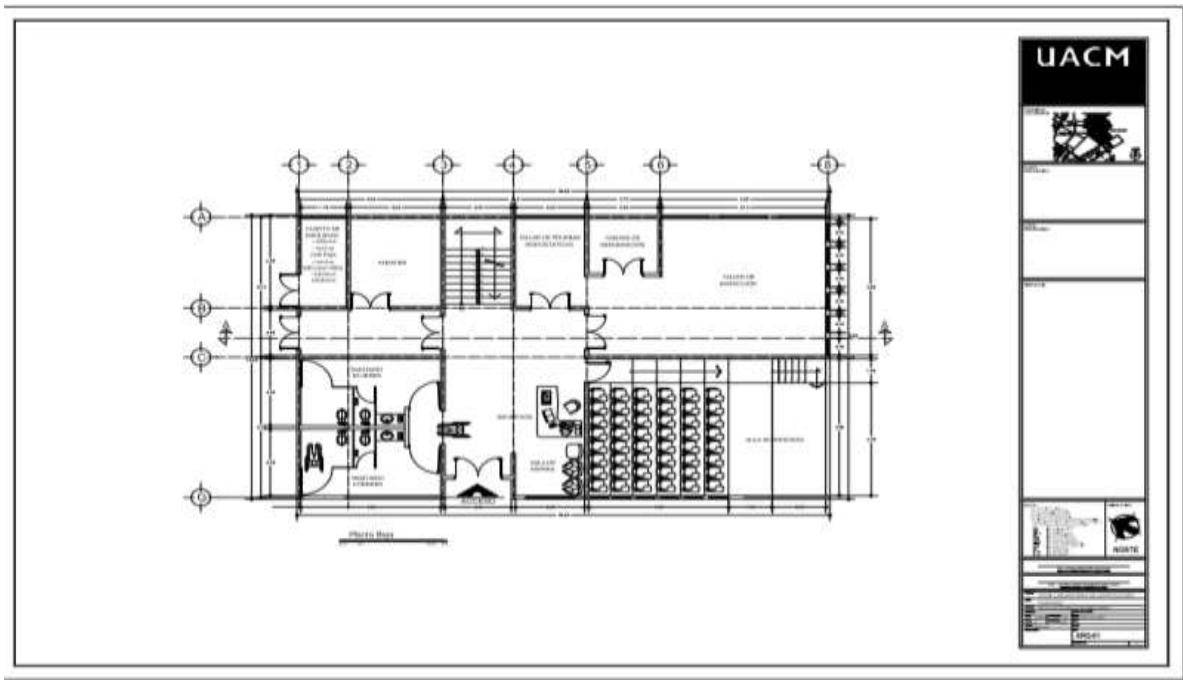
Plano de la planta inferior del laboratorio. Fuente: Coordinación de obras y Conservación UACM
